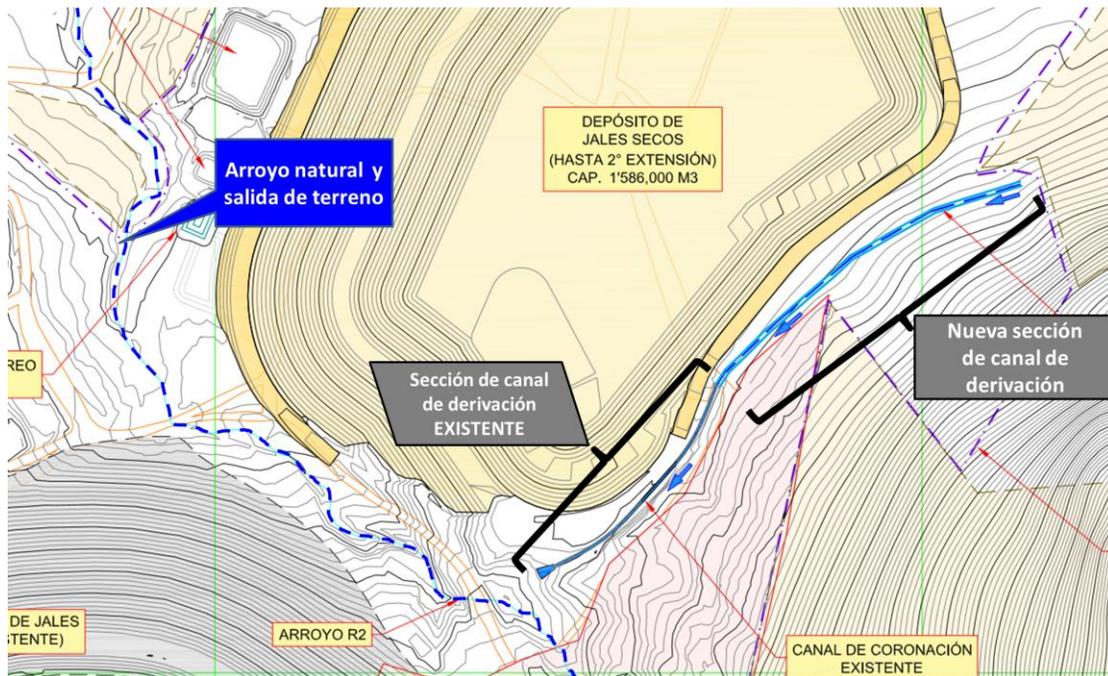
11. Canal de derivación de agua pluvial en ladera baja cerril (al Sureste de ampliación)
